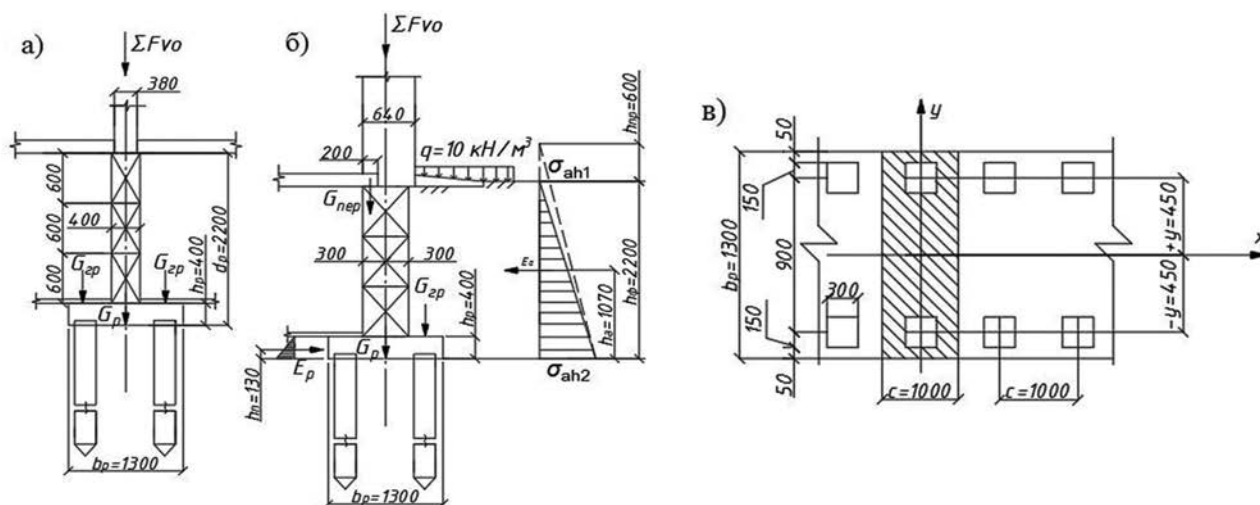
Расчетная схема ленточного свайного фундамента: а — центральное нагружение; б — внецентренное нагружение; в — схема ростверка в плане
